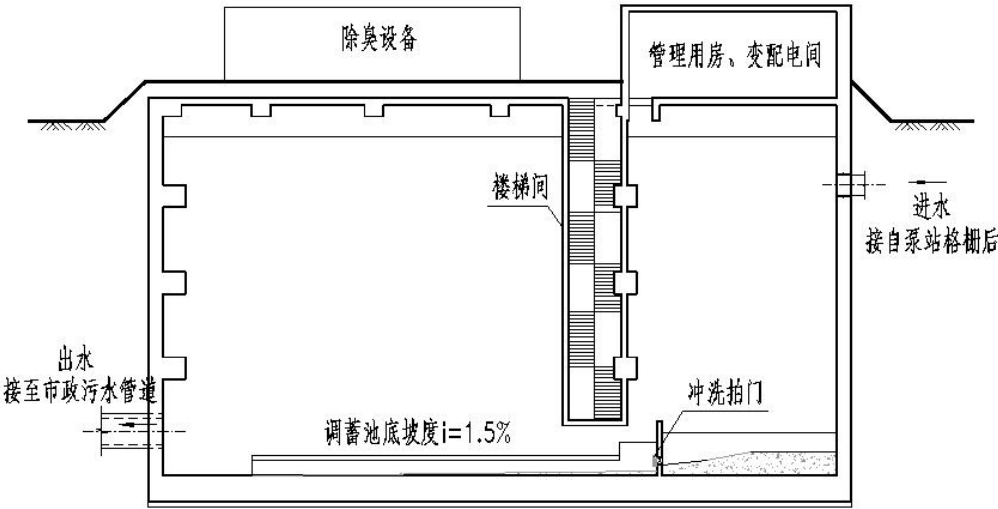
半地上式钢筋混凝土调蓄池立面示意图
